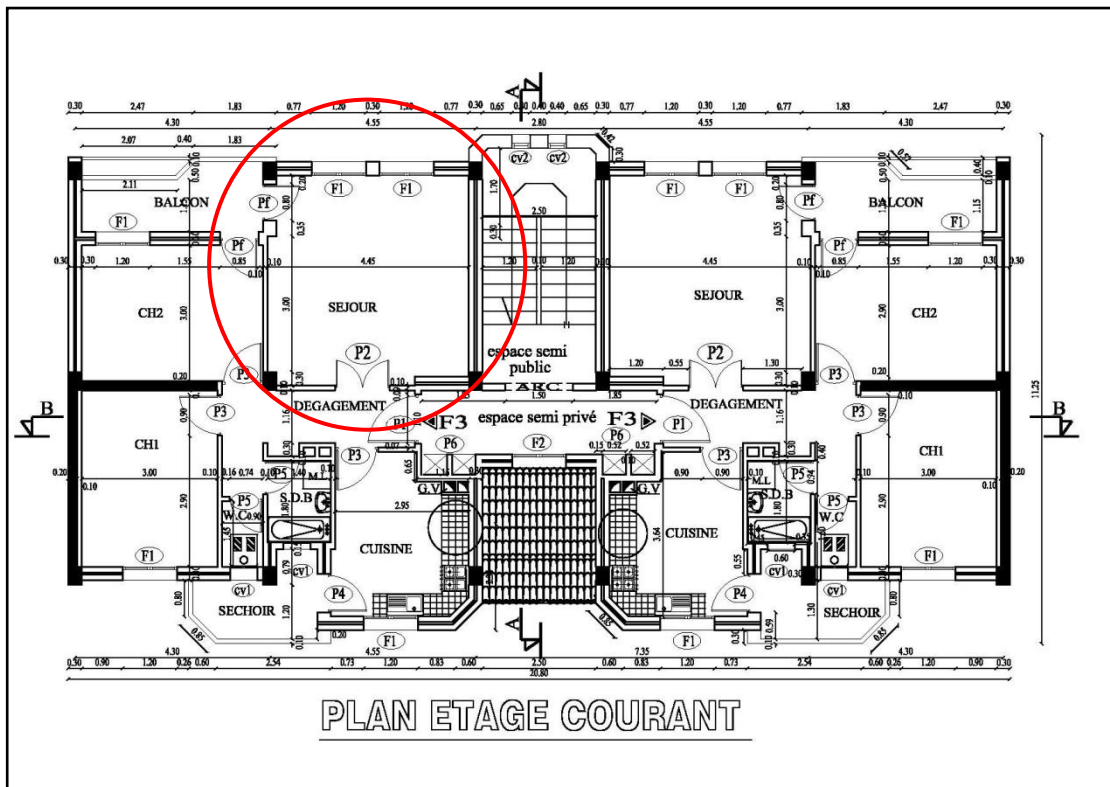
Plan étage courant d'un logement collectif à Jijel.
